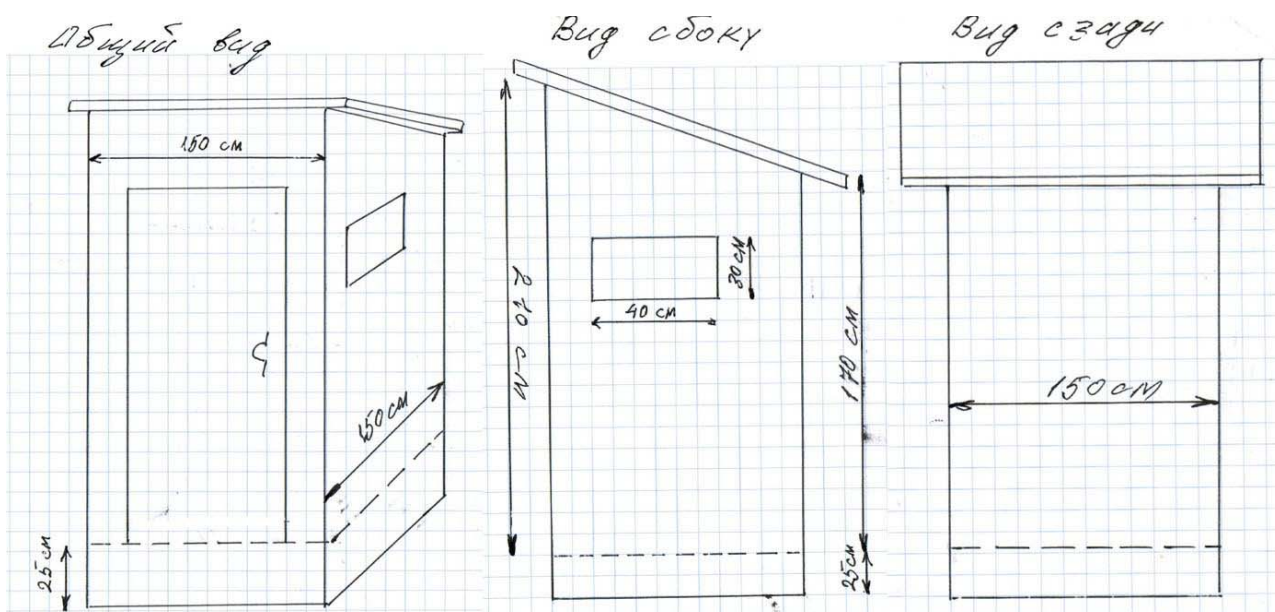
План-схема туалета щитового на ранчо "Золотая подкова"
